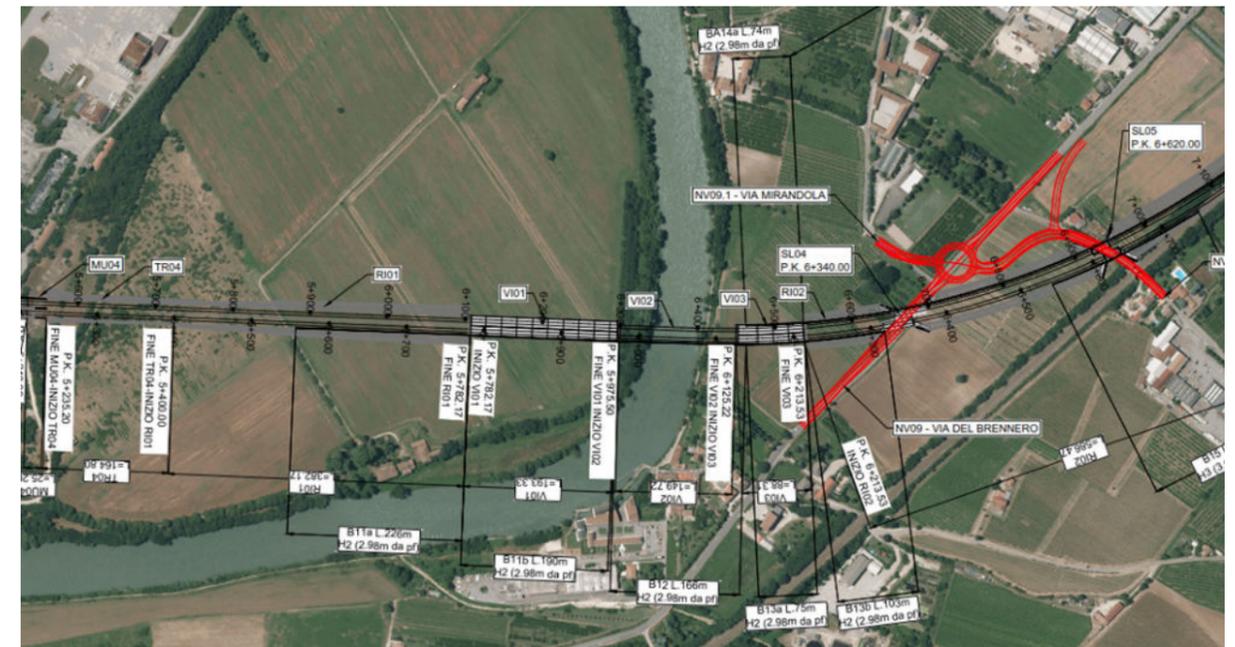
Planimetria delle opere VI01, VI02, VI03 su ortofoto
